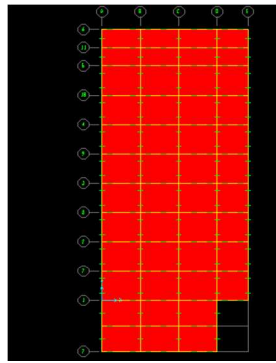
Denah Lantai Basement 2 Hotel Grand Jambo Jember
